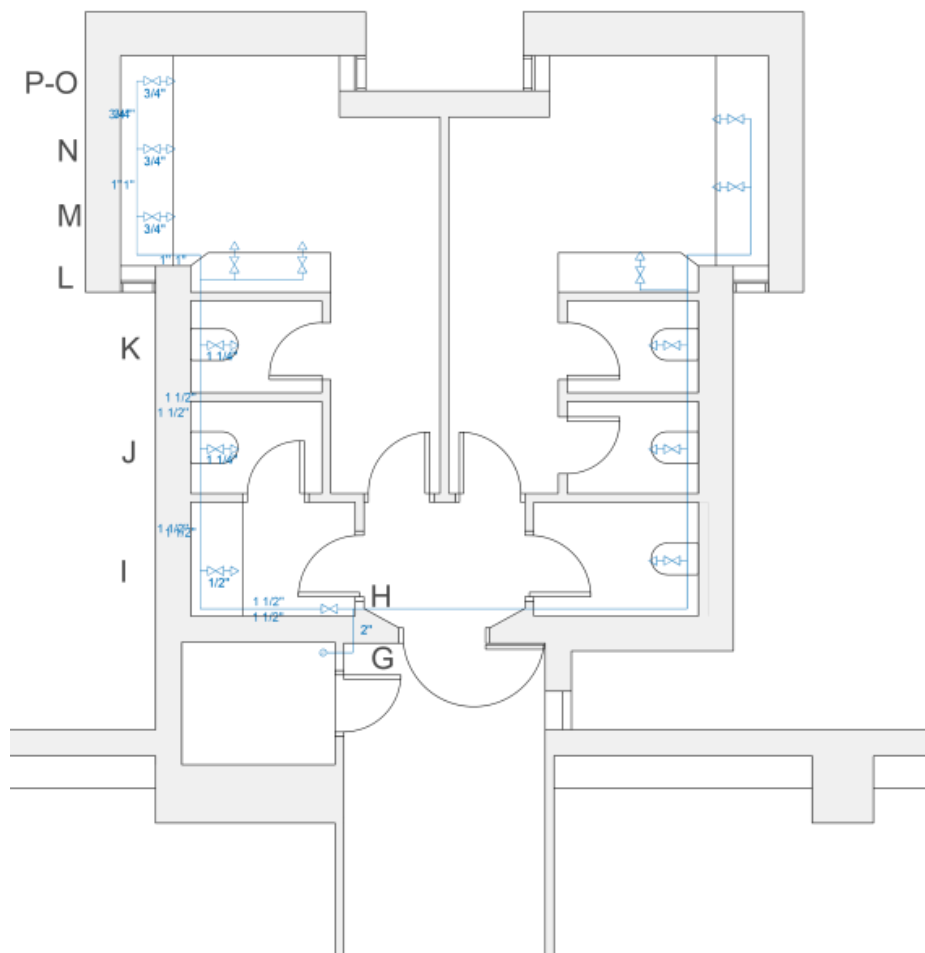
Planta baño chicos/as del ala Norte de la biblioteca
